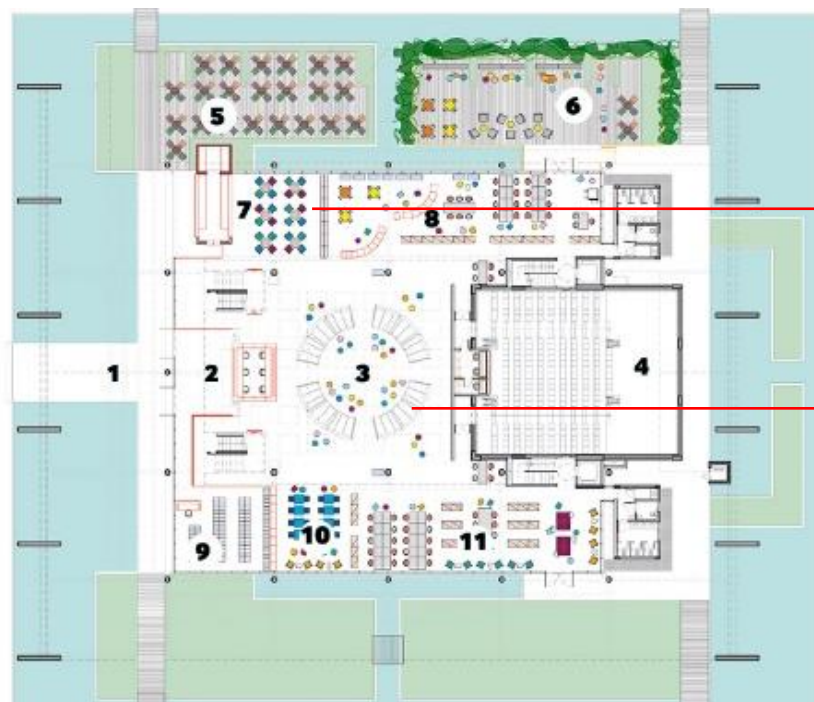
Planta baixa térreo Biblioteca Villa Lobos. Fonte: Archdaily (2019a).
